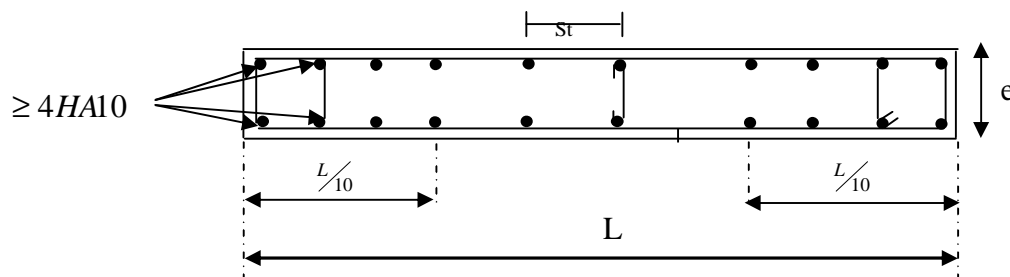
Disposition des armatures verticales dans les voiles
